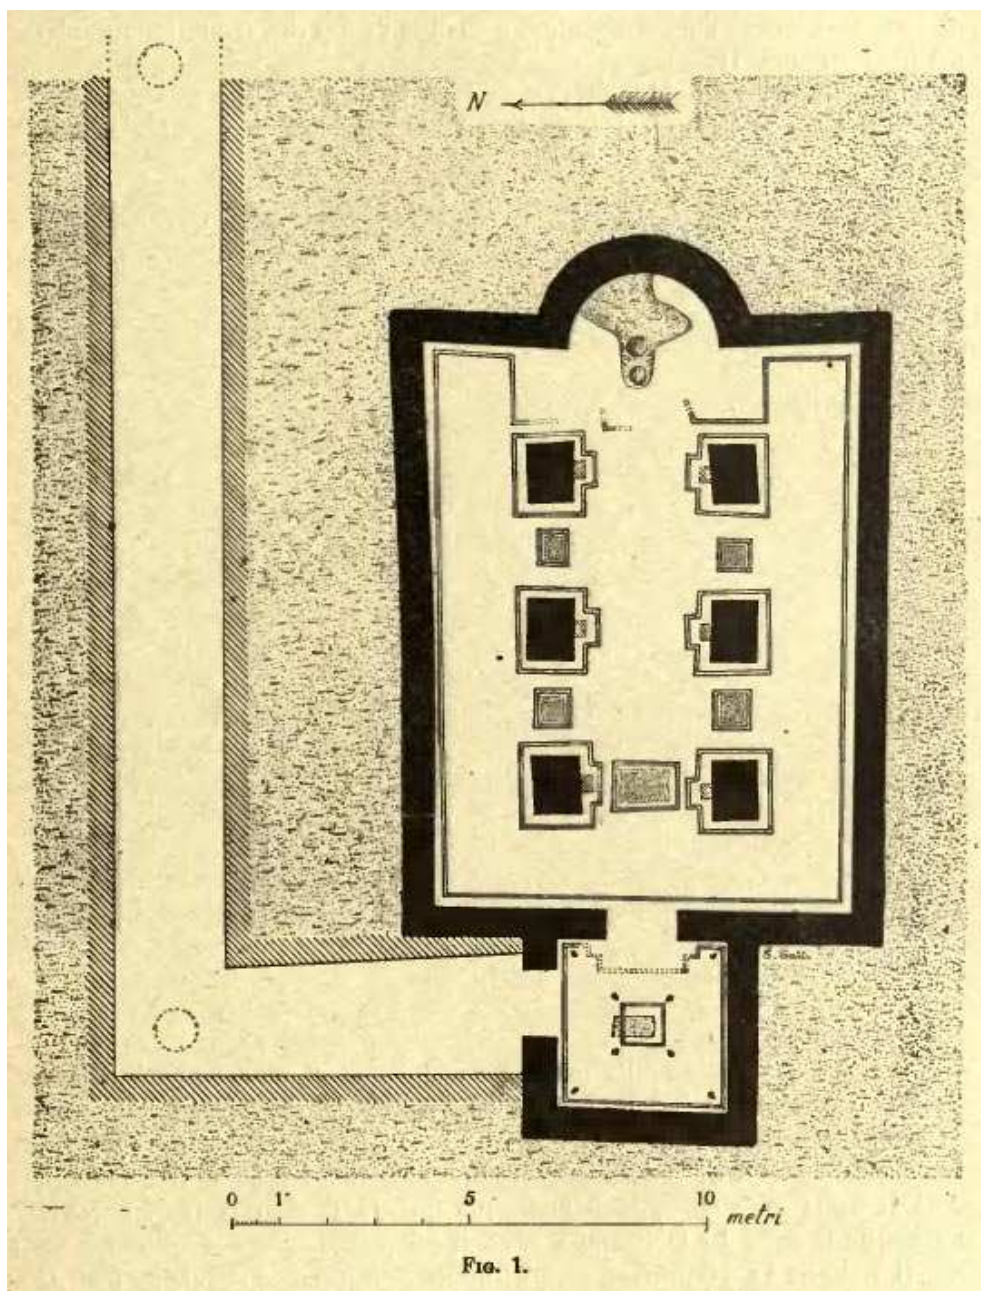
Planimetria della Basilica (Gatti, 1918).
